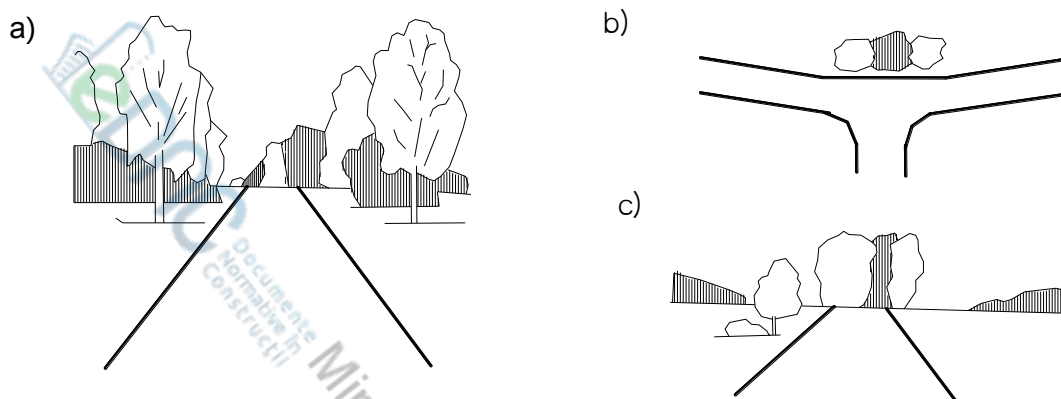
Utilizarea plantațiilor pentru evidențierea direcției drumului
